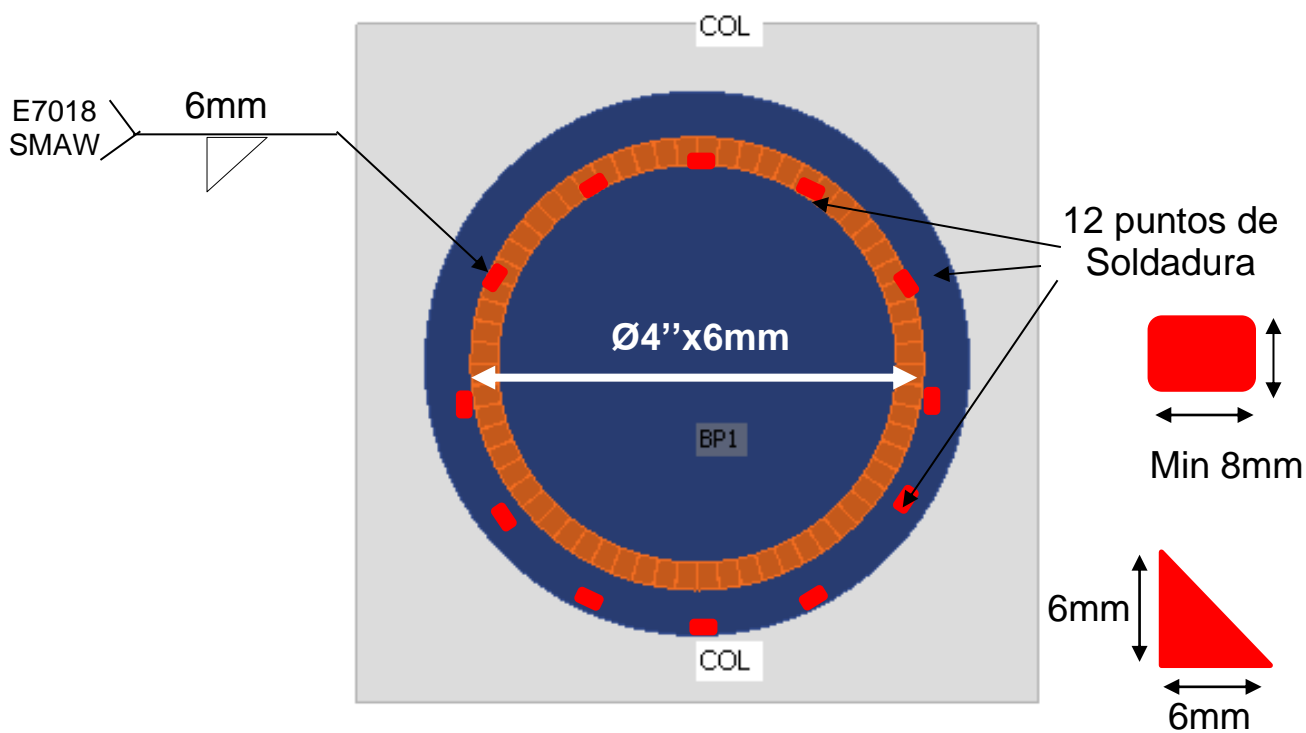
Vista planta Conexión de Bolardo, Puntos de soldadura.
